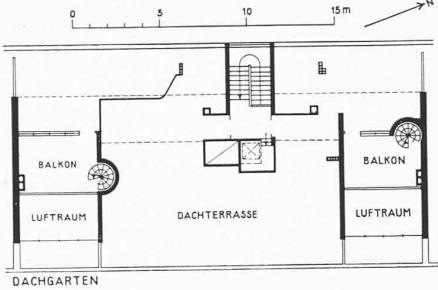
bis 5. Grundrisse 1:400.
